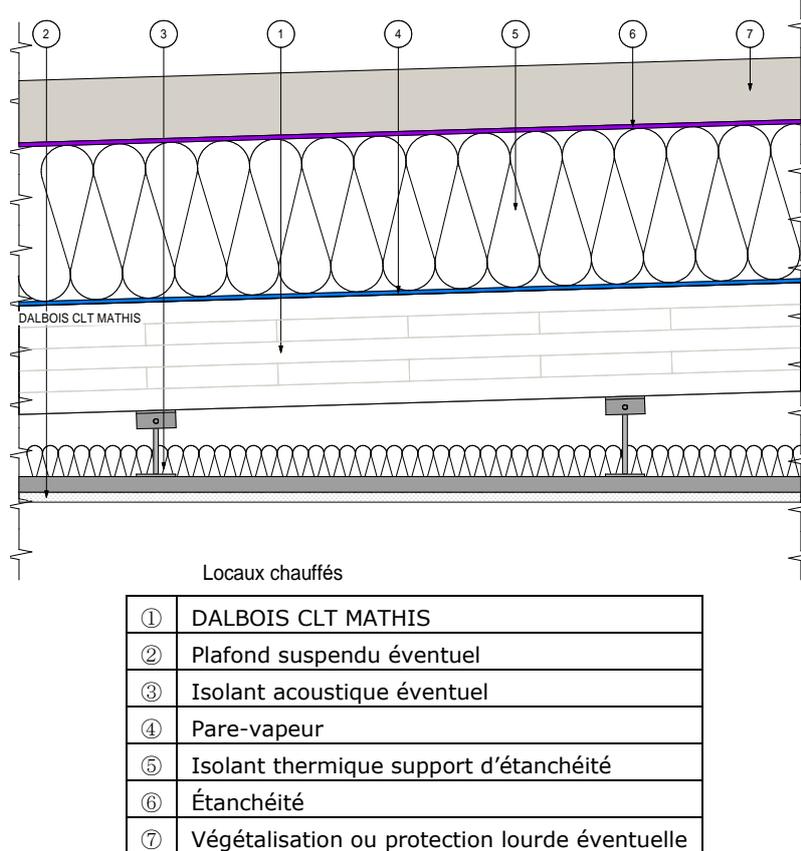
Utilisation d'un CLT DALBOIS CLT-M en configuration de toiture isolée sur bâtiment chauffé– Toiture inaccessible, technique et végétalisée – Isolation support d'étanchéité
